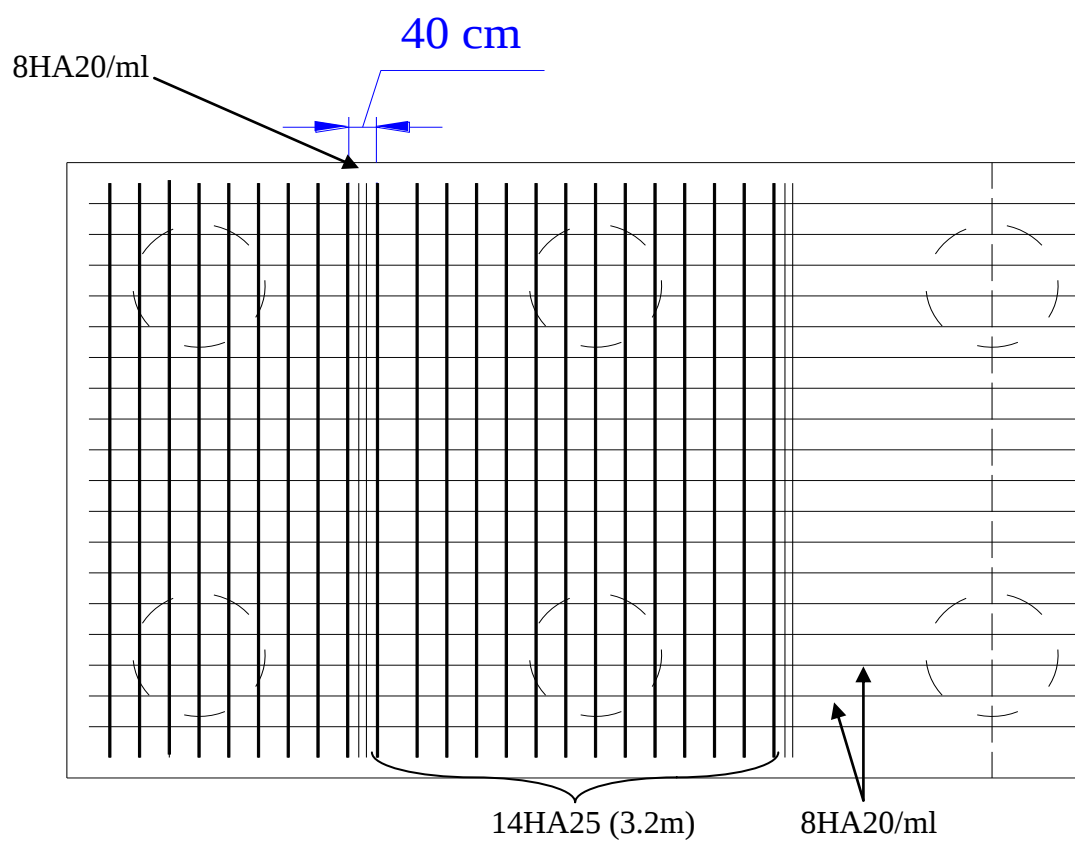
Ferrailage de la semelle (nappe inférieure)
